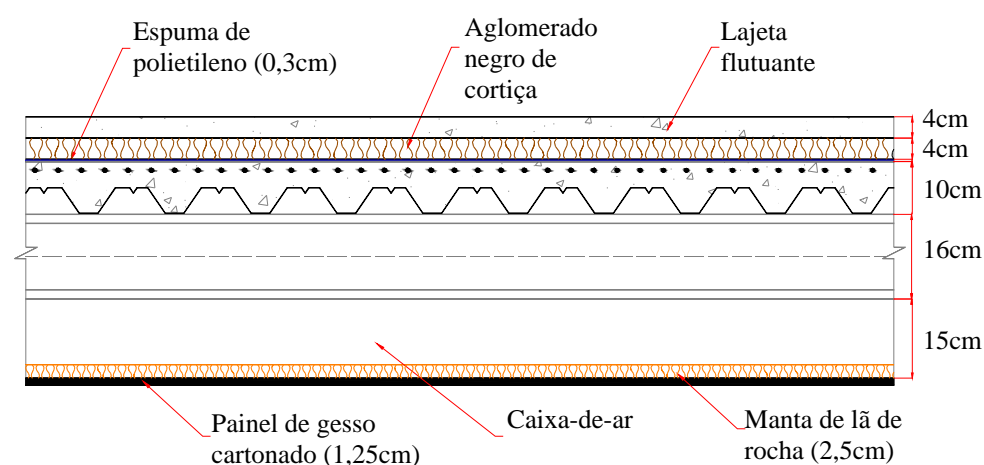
Pavimento misto de cofragem metálica colaborante com tecto falso, isolante térmico e lajeta flutuante (Pav12)
